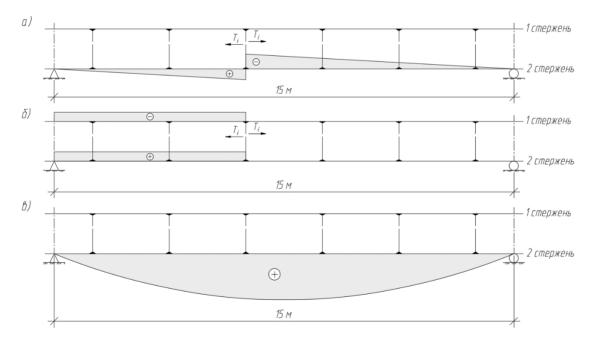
Общий вид единичных и грузовой эпюр в основной системе: а — единичная эпюра  $\overline{M}_i$  , 6 — единичная эпюра,  $\overline{N}_i$  в — грузовая эпюра
